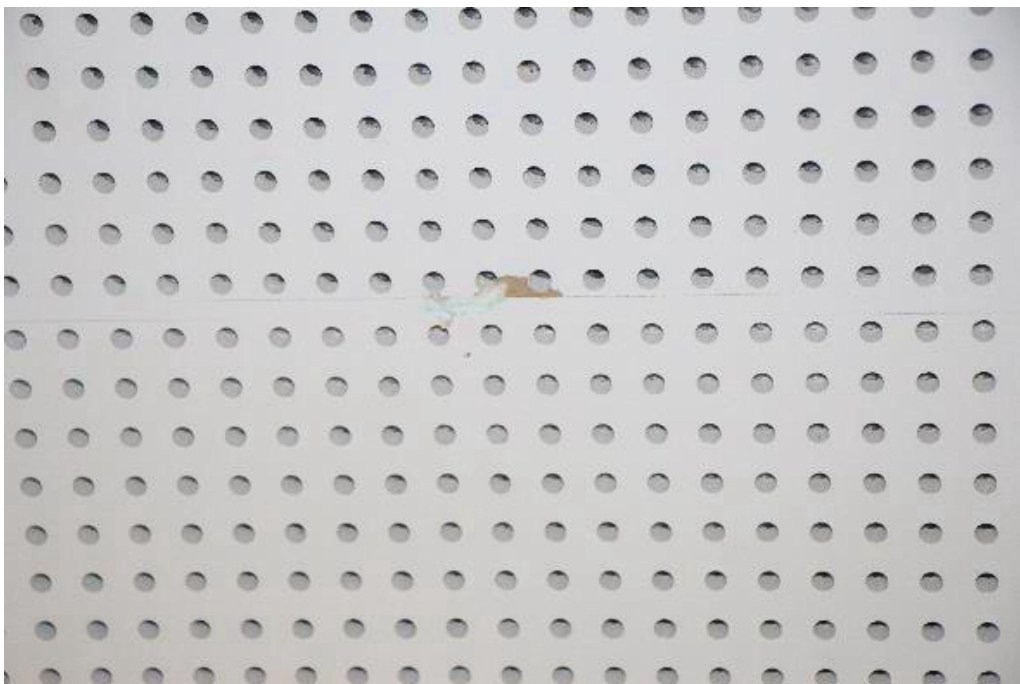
0382-0563-EG-Garderobe, Deckenspachtel (Detailaufnahme)
